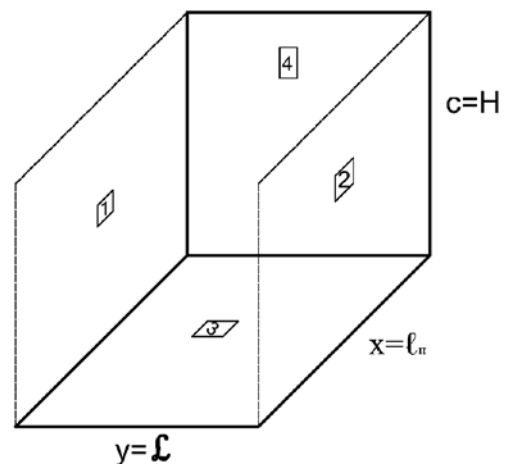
Схема к расчету коэффициентов связи между фасадом здания 4 и участком земной поверхности 3 между зданиями 1, 2, 4
